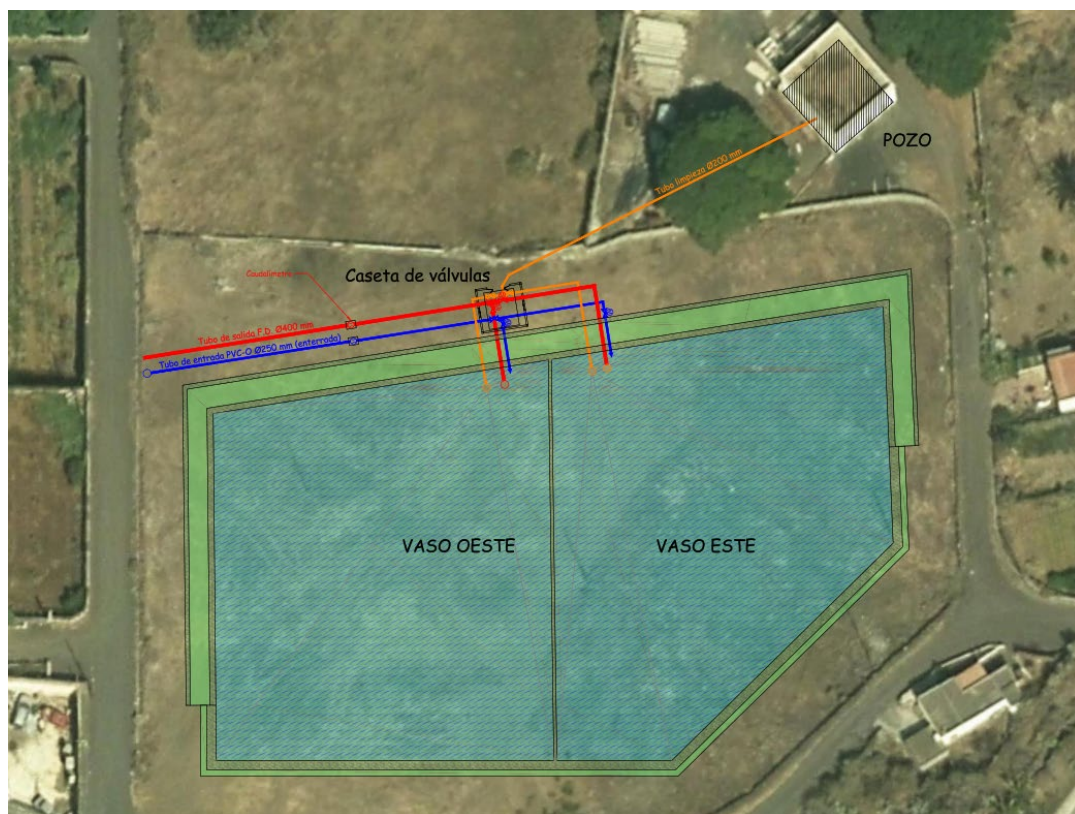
Planta del depósito de 2 vasos de hormigón ciclópeo
